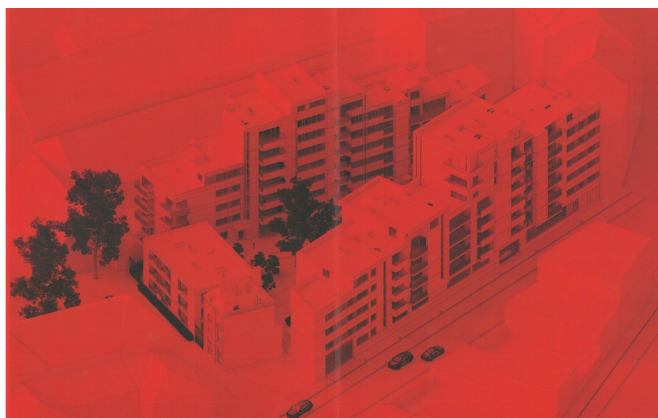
Façade du côté du parc de l'Ecole Vétérinaire (Pierre Accarain – Marc Bouillot Architectes Associés, 2016)
